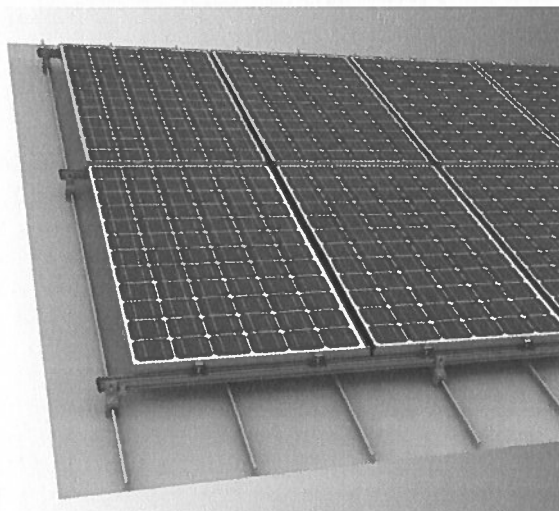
Sistem montaj module PV – montaj pe acoperis tip sarpana
